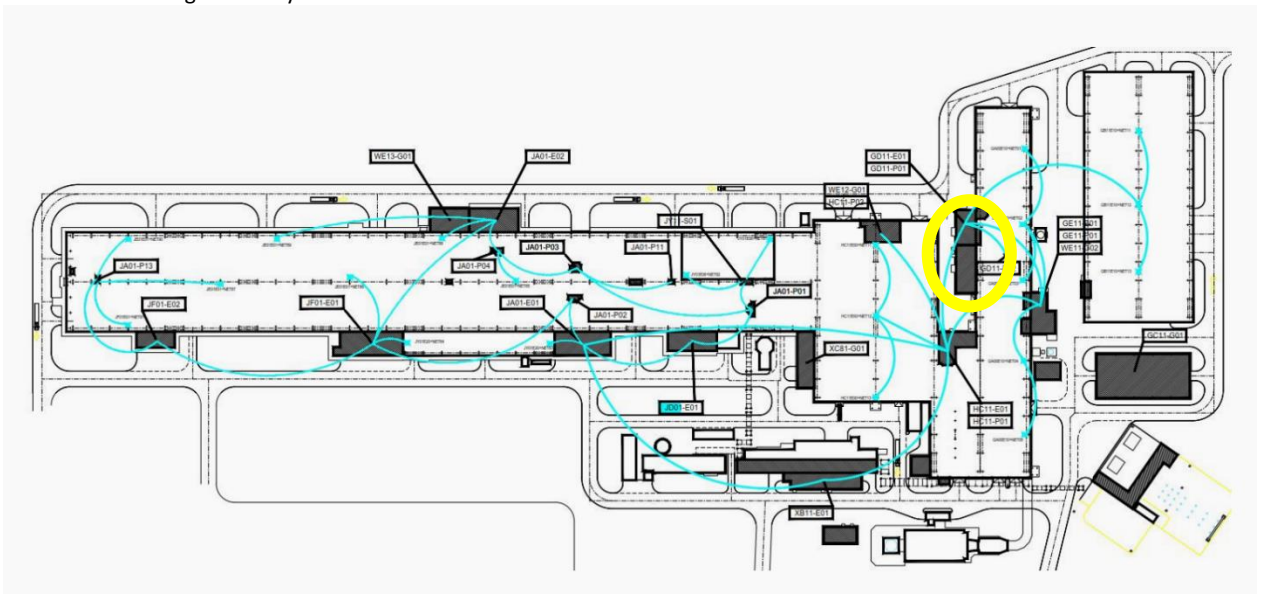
Remota seleccionada en base a layout. Fuente: LAYOUT Laminador Planta 2
